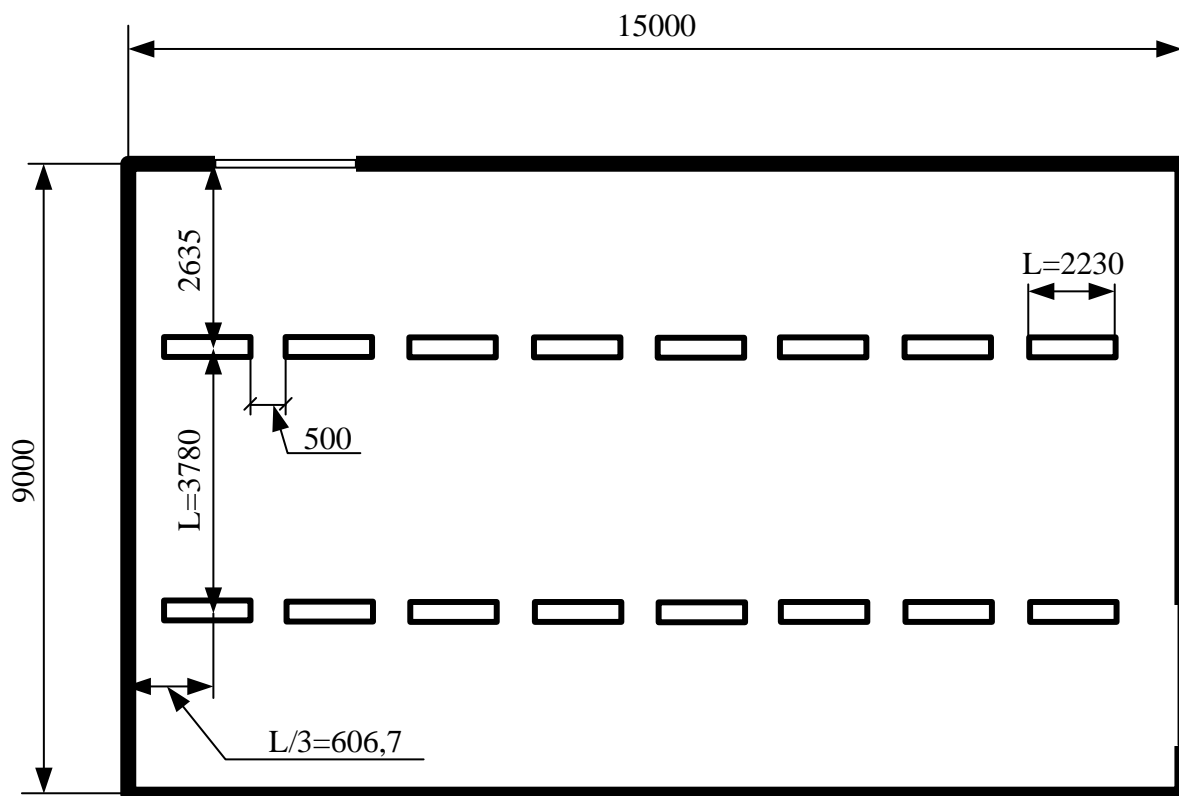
Схема размещения светильников в помещении, где $L/3$ – оптимальное расстояние от крайних светильников или рядов до стены
